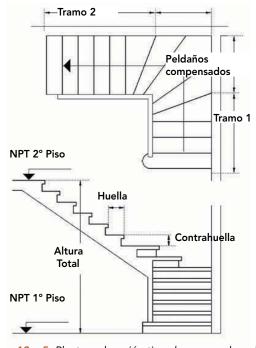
5: Planta y elevación tipo de una escalera de dos tramos en ángulo recto con peldaños compensados.
